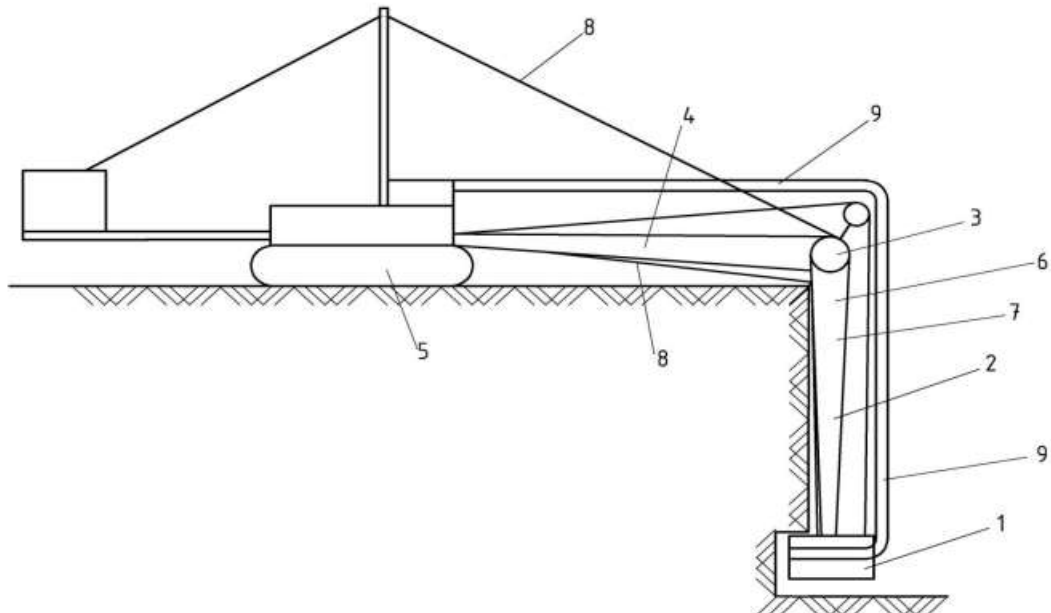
Механическая подрезка уступа фрезерным рыхлителем:
